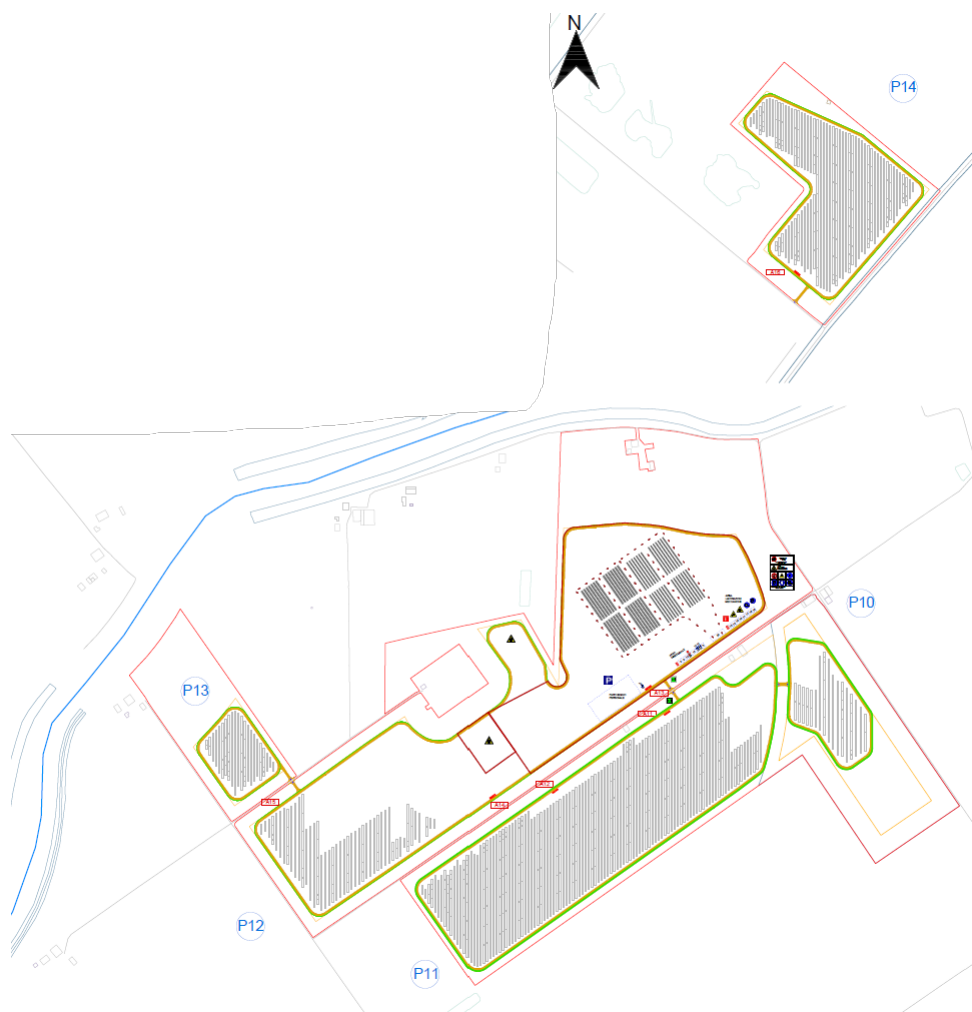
Cantiere durante le fasi di installazione strutture e moduli
